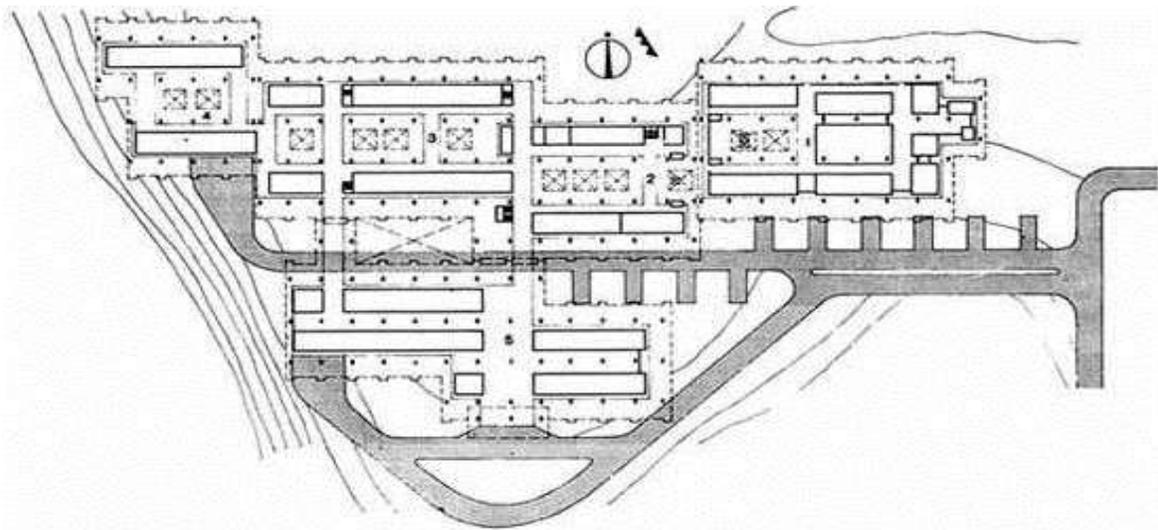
Planta da solução de pilares independentes e dos blocos da UFAM. Fonte: Revista AU 81, 1998.
